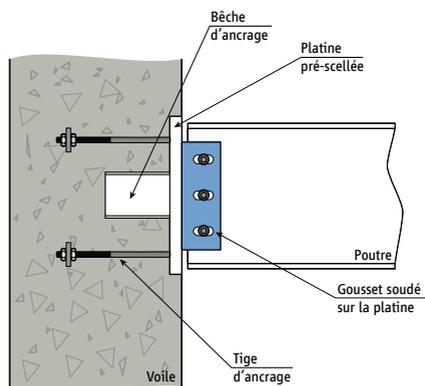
Ancrages dans un voile par platine pré-scannée avec tiges d'ancrage
